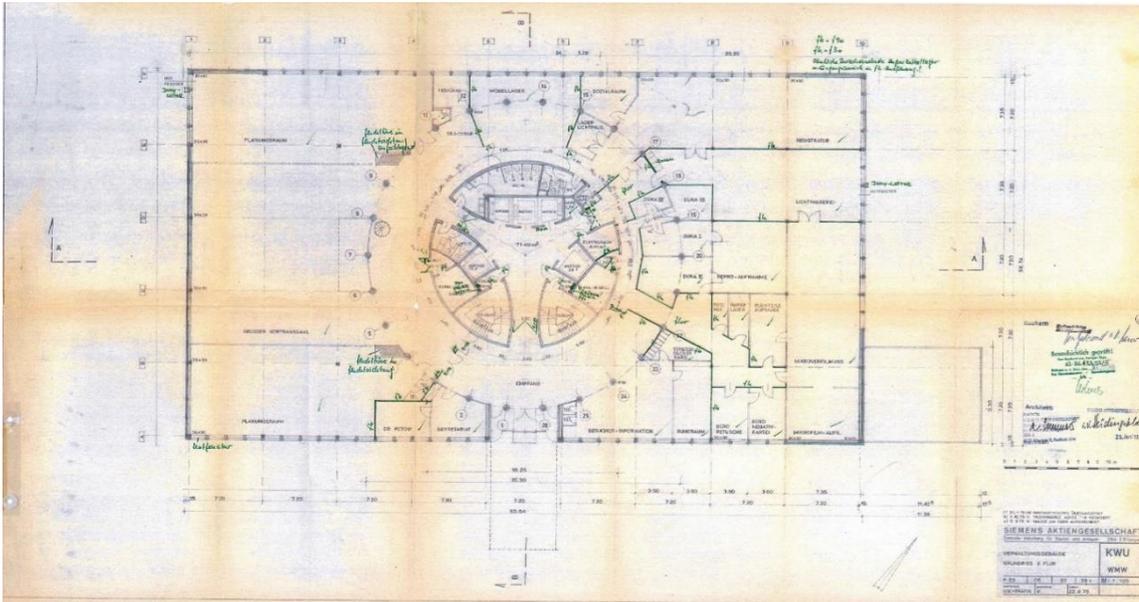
KWU-Gebäude, Grundriss Erdgeschoss, Bauakte
